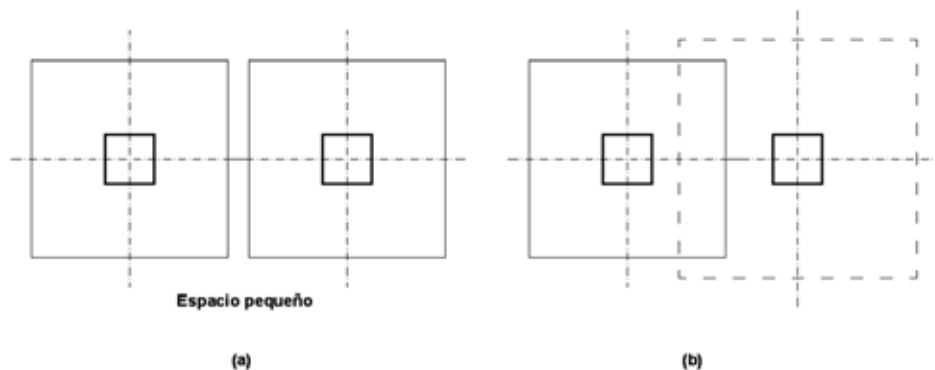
A.Zapatas aisladas. B.Zapatas traslapadas
